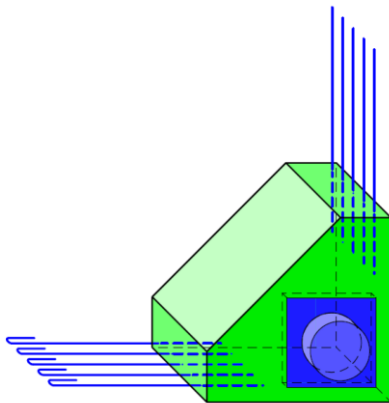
Lisene als Fertigteil mit Anschlussbewehrung
